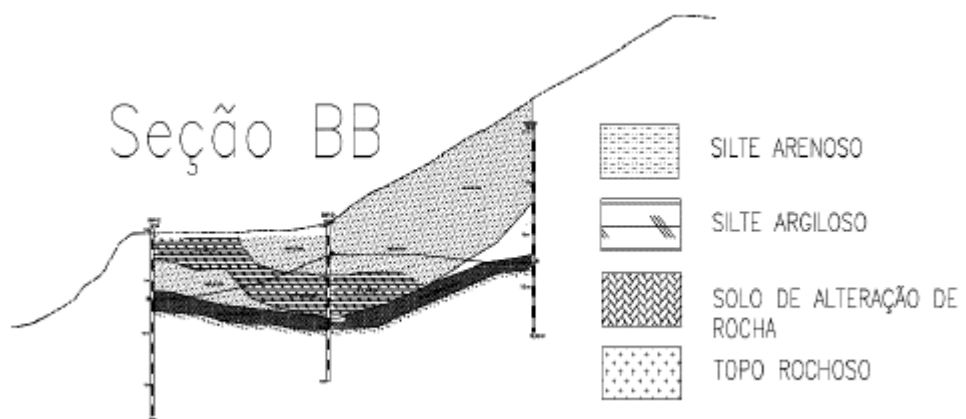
Perfil Geotécnico definido pelas Sondagens Mistas – Seção “BB”
